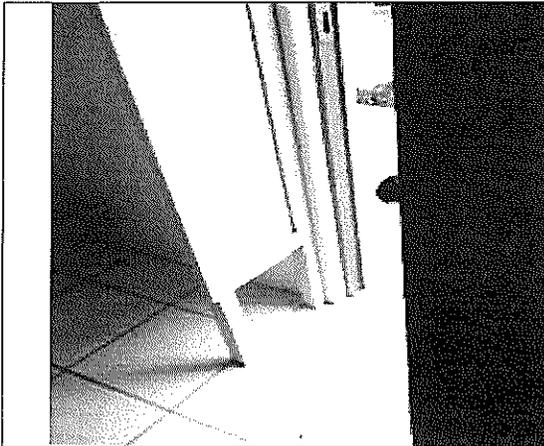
Cambio de pavimento sin cubrejuntas.
